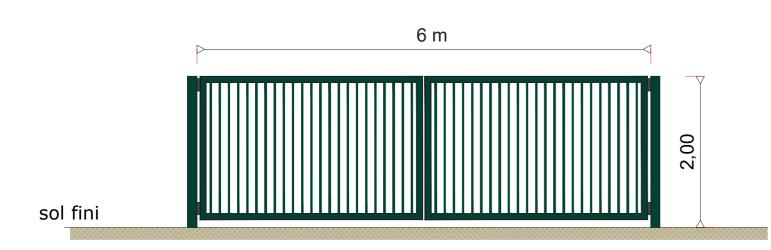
DETAILS - ÉLÉVATIONS DU PORTAIL D'ENTRÉE ET DE LA CLÔTURE - échelle 1/40e
